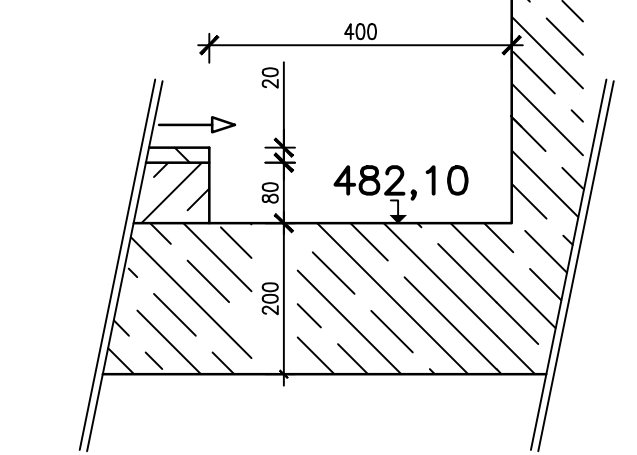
DETAIL ÚPRAVY SBĚRNÉ JÍMKY M 1:10
